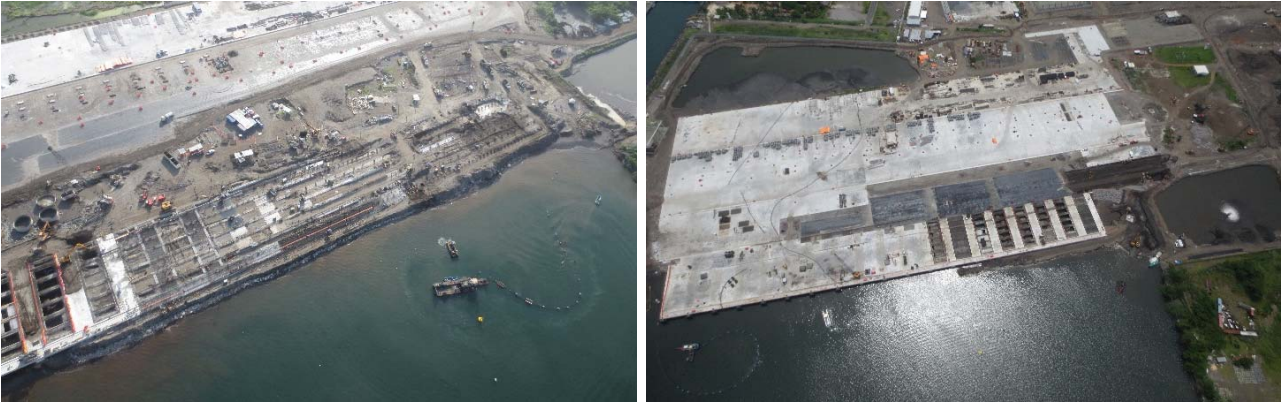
, 11b. Vista general del muelle durante la ejecución de los pilotes, las vigas longitudinales, y la losa en zona de fingers. Vista general del muelle durante la ejecución de la losa.
